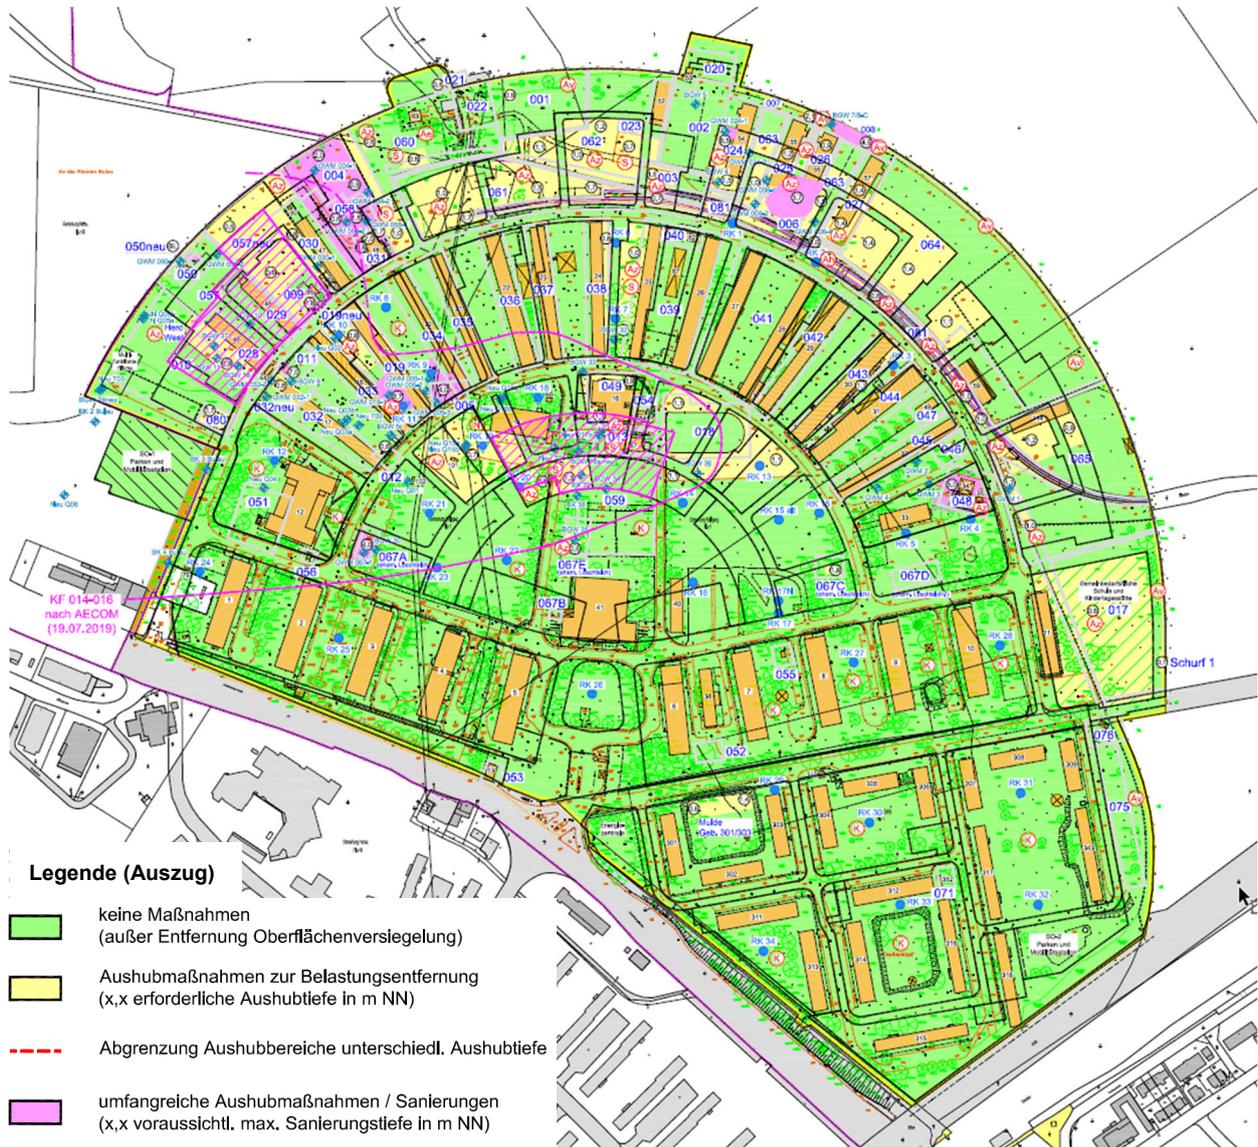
Grundlagenplan zur Maßnahmendurchführung.
